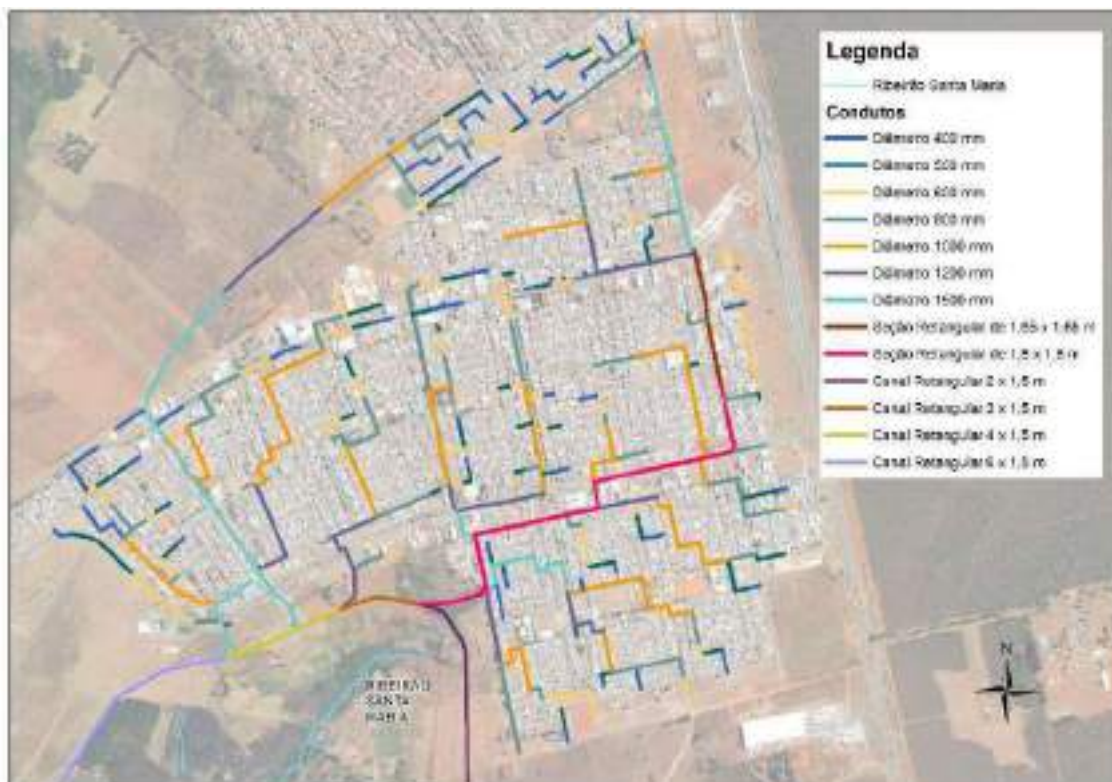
Dimensões das tubulações ao longo da rede de drenagem
